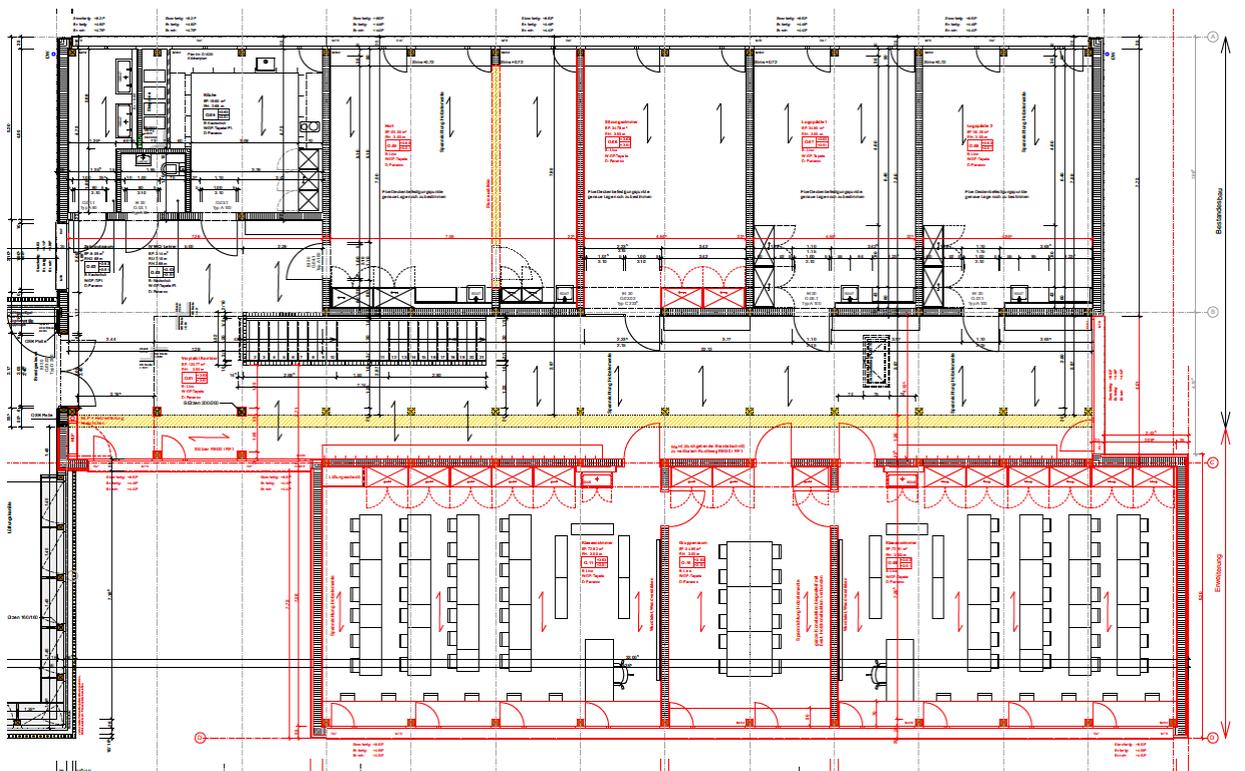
Grundriss Obergeschoss (Planstand TU-Ausschreibung)
